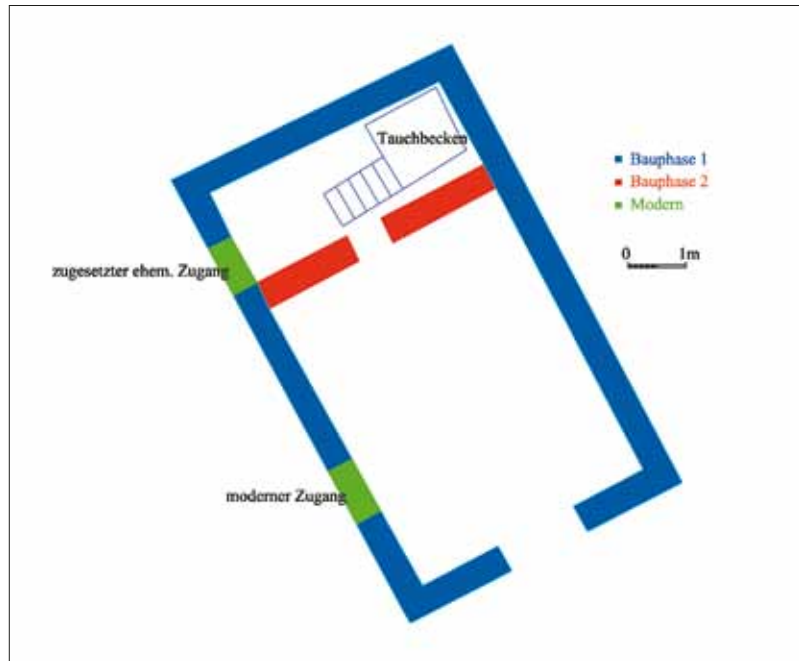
Grundriss des Kellers mit Bauphasen und Skizze der Mikwa in Kellerraum 2.
